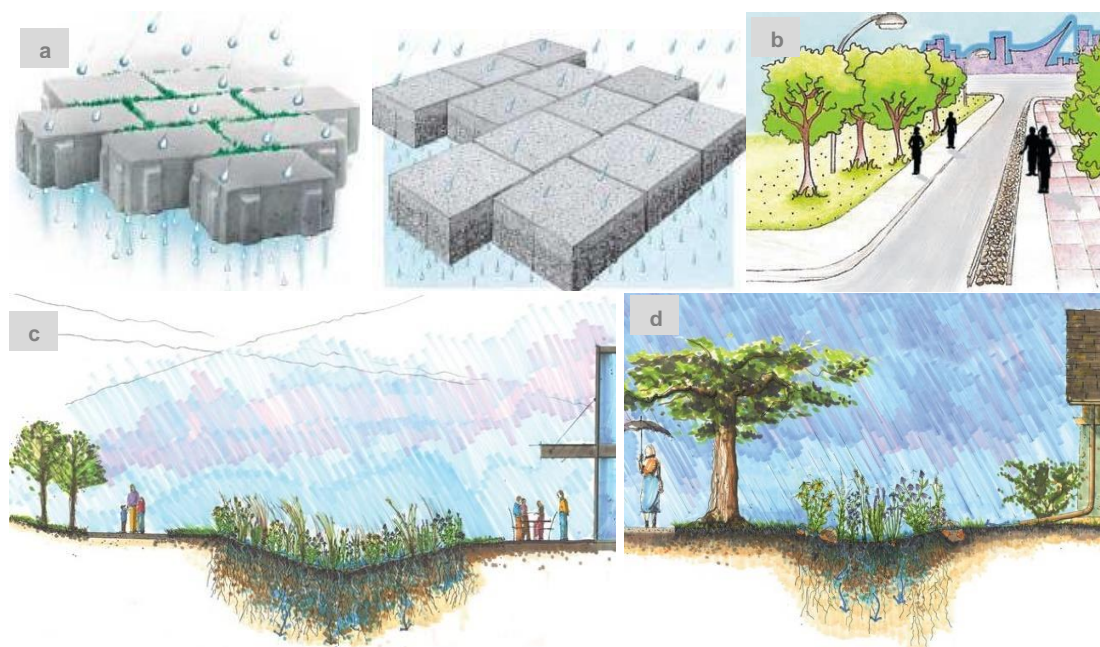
Estruturas de drenagem sustentável: a) Pavimentos permeáveis; b) Trincheira de infiltração; c) Vala de infiltração; d) Rain garden.
